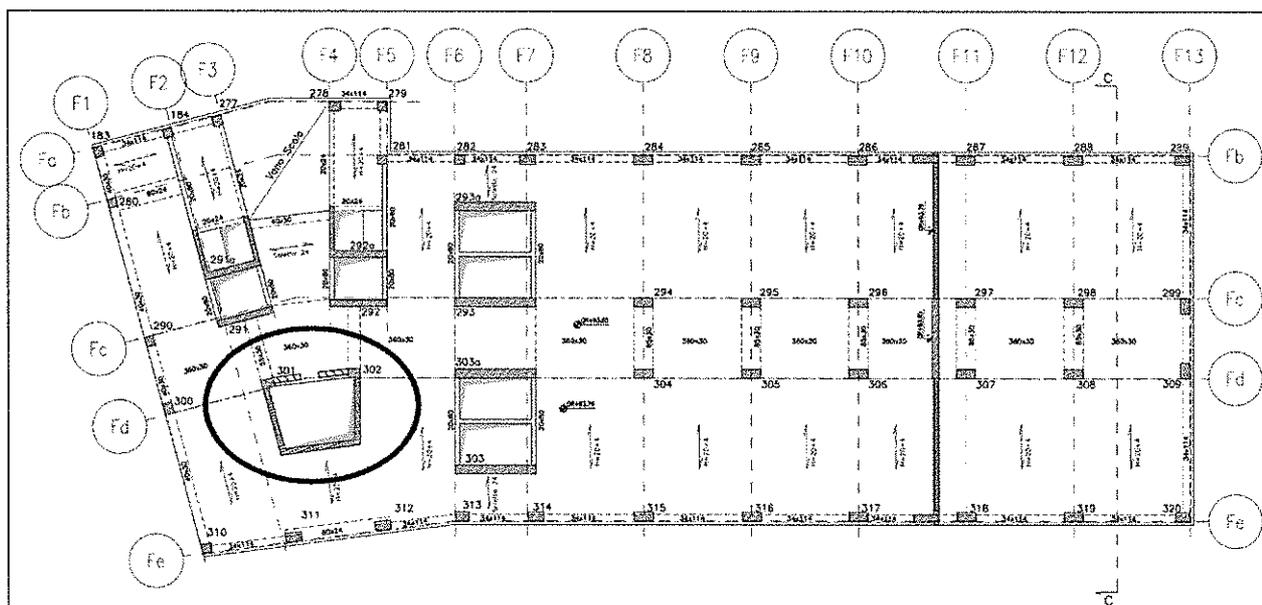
Edificio F - Carpenteria tipo con l'indicazione del cavedio impianti
